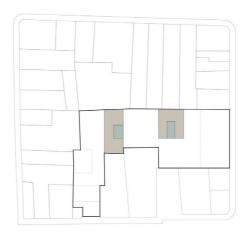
Zonificación Tercera Planta Alta Fuente: Autores, 2022
